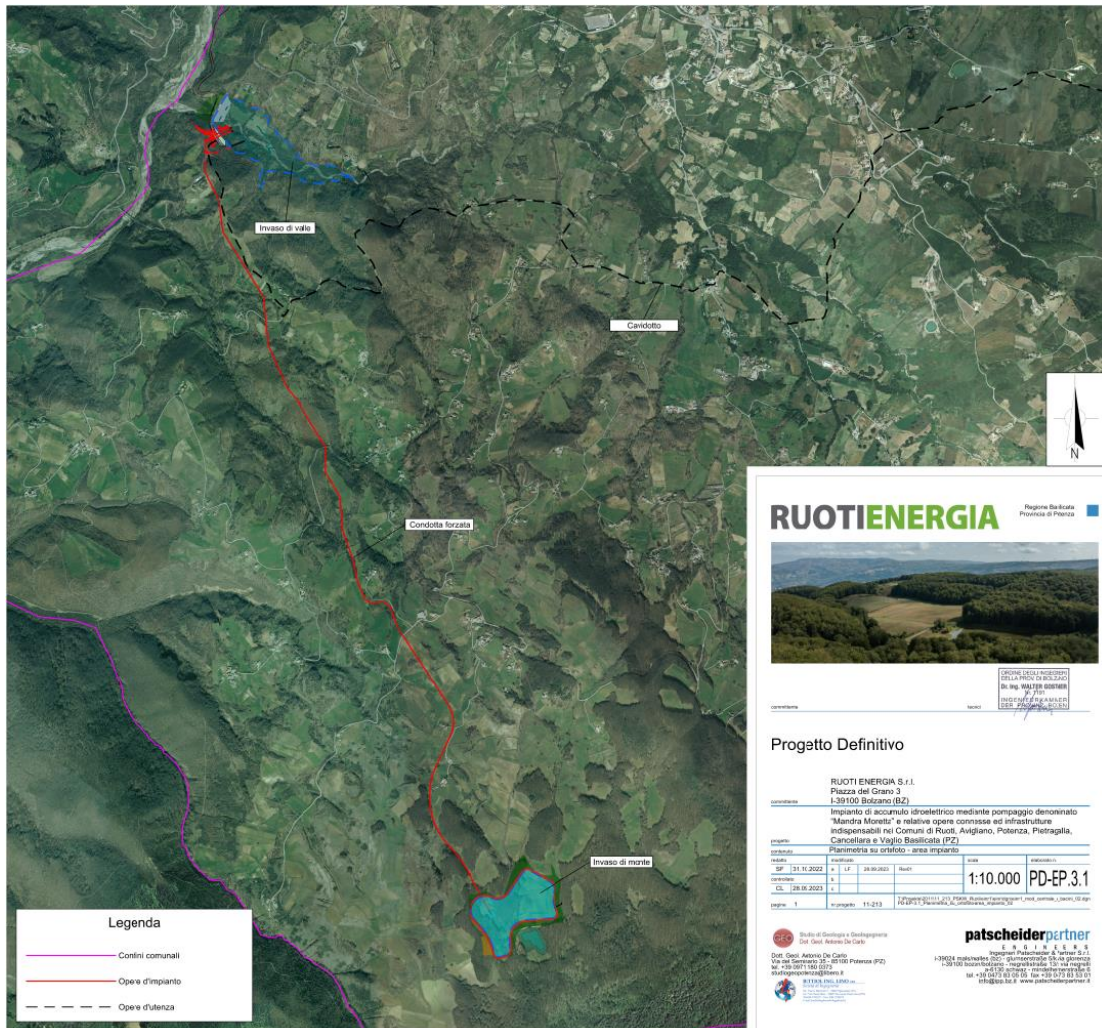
Planimetria su ortofoto dell'area di impianto (elaborato PD-EP.3.1 del progetto definitivo)
